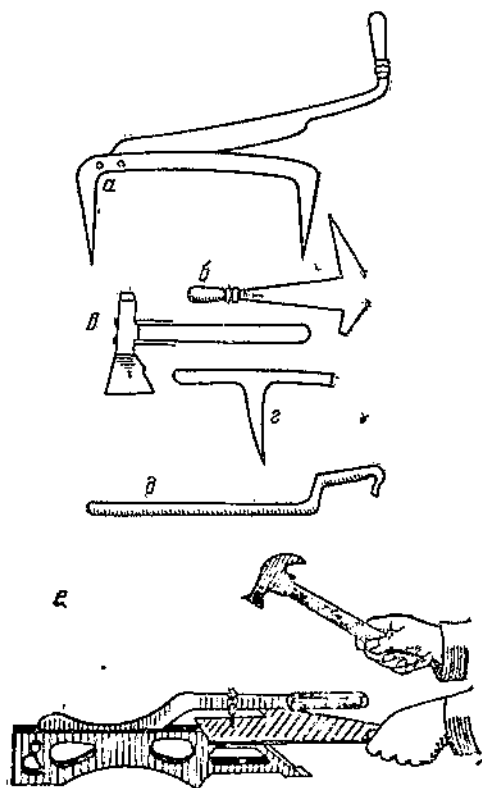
Инструменты, служащие для покрытия кровли асбоцементными плитками.
